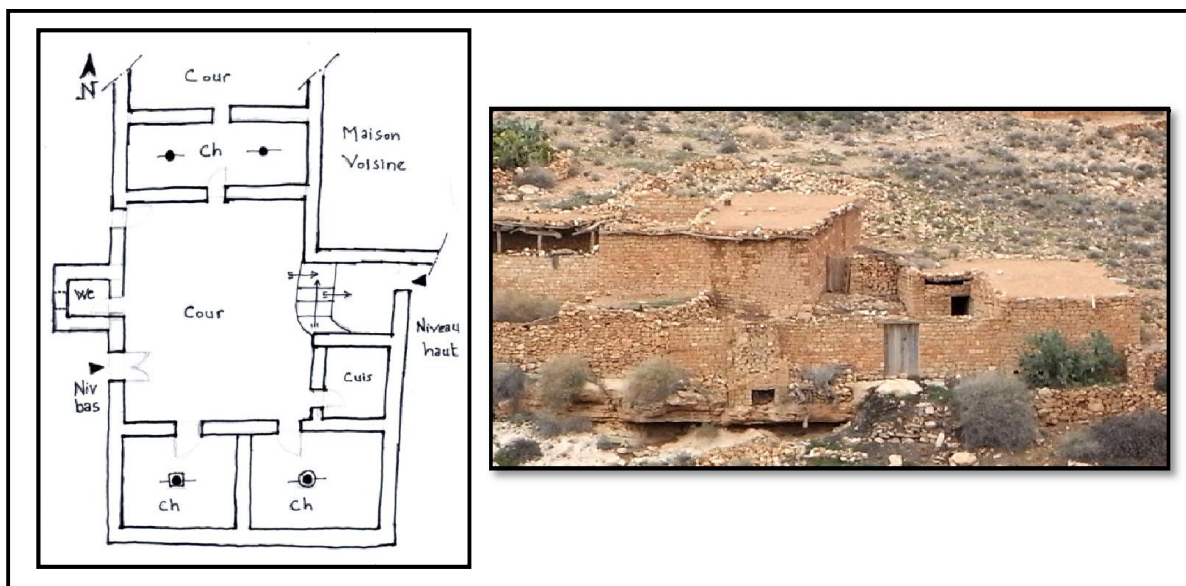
, 3.12: Plan et photo de la maison traditionnelle de la famille Belaieche à Hiza.
